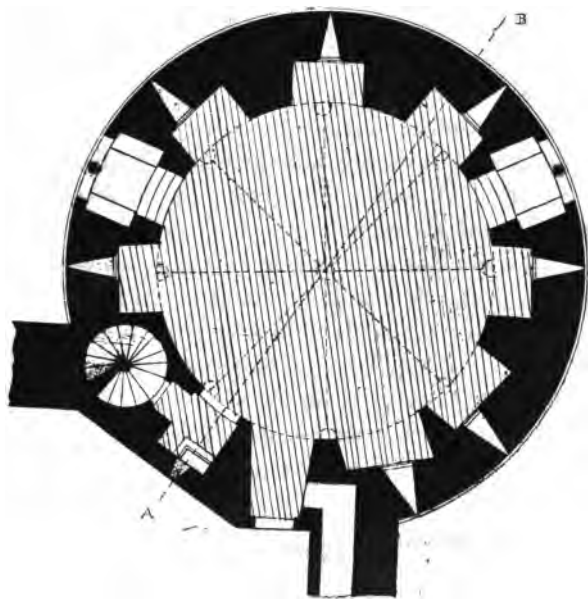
PLAN DU 1^{er} ÉTAGE DU DONJON.
